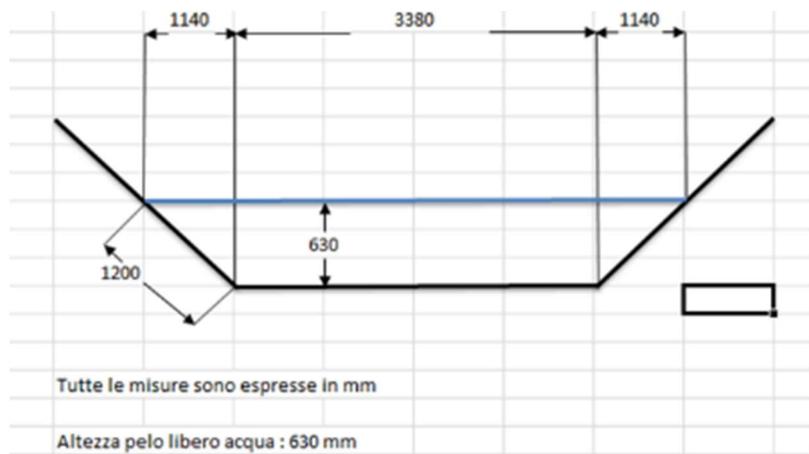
Schema sezione tipo del canale<sup>1</sup>
